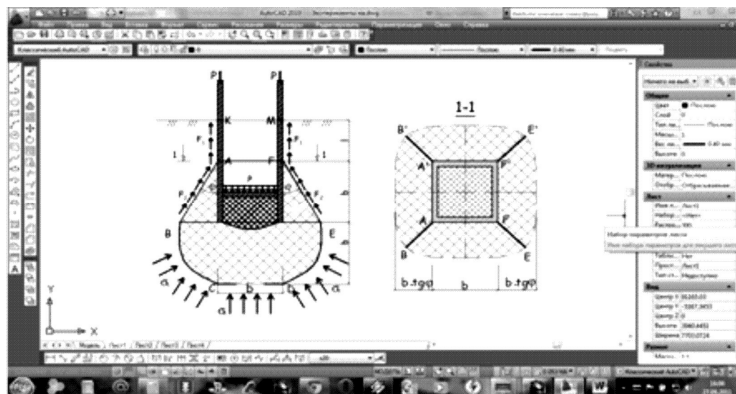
Расчетная схема деформирования основания глубокого фундамента
